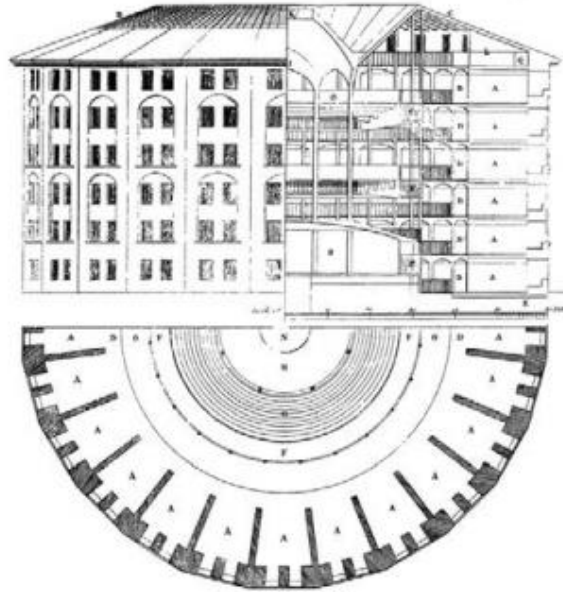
Planta y sección del Panóptico de Jeremy Bentham (1780).
